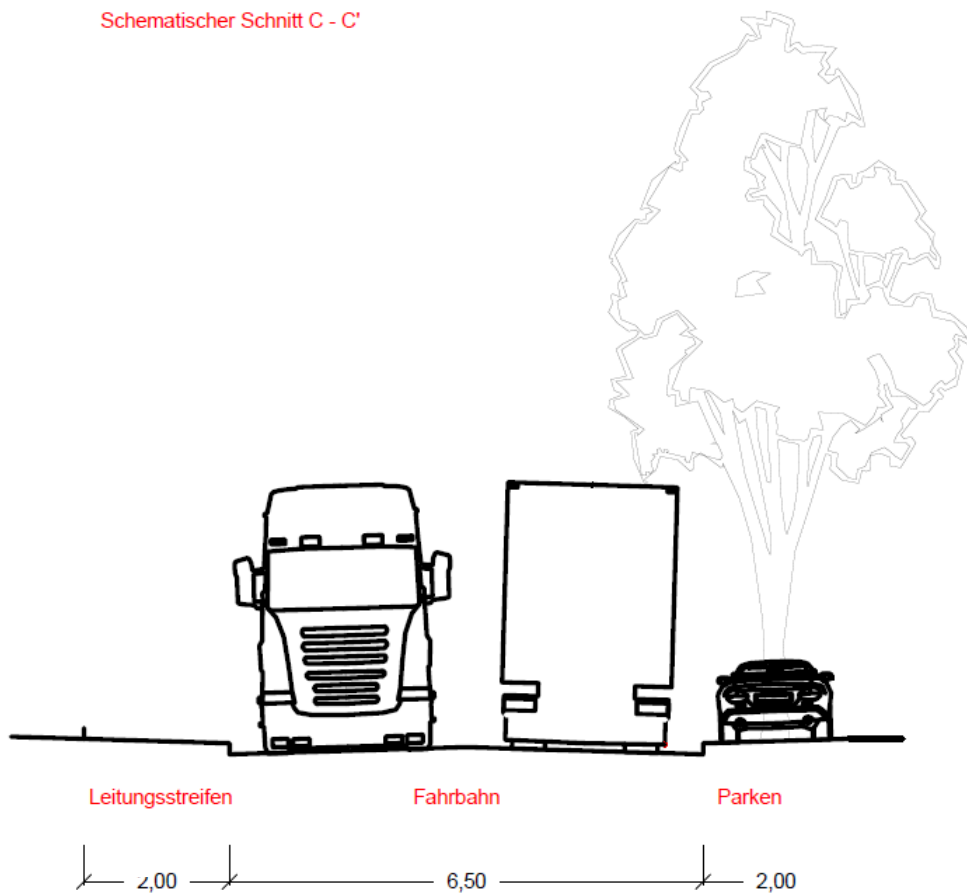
Straßenquerschnitt Anbindung Bauabschnitt 6
